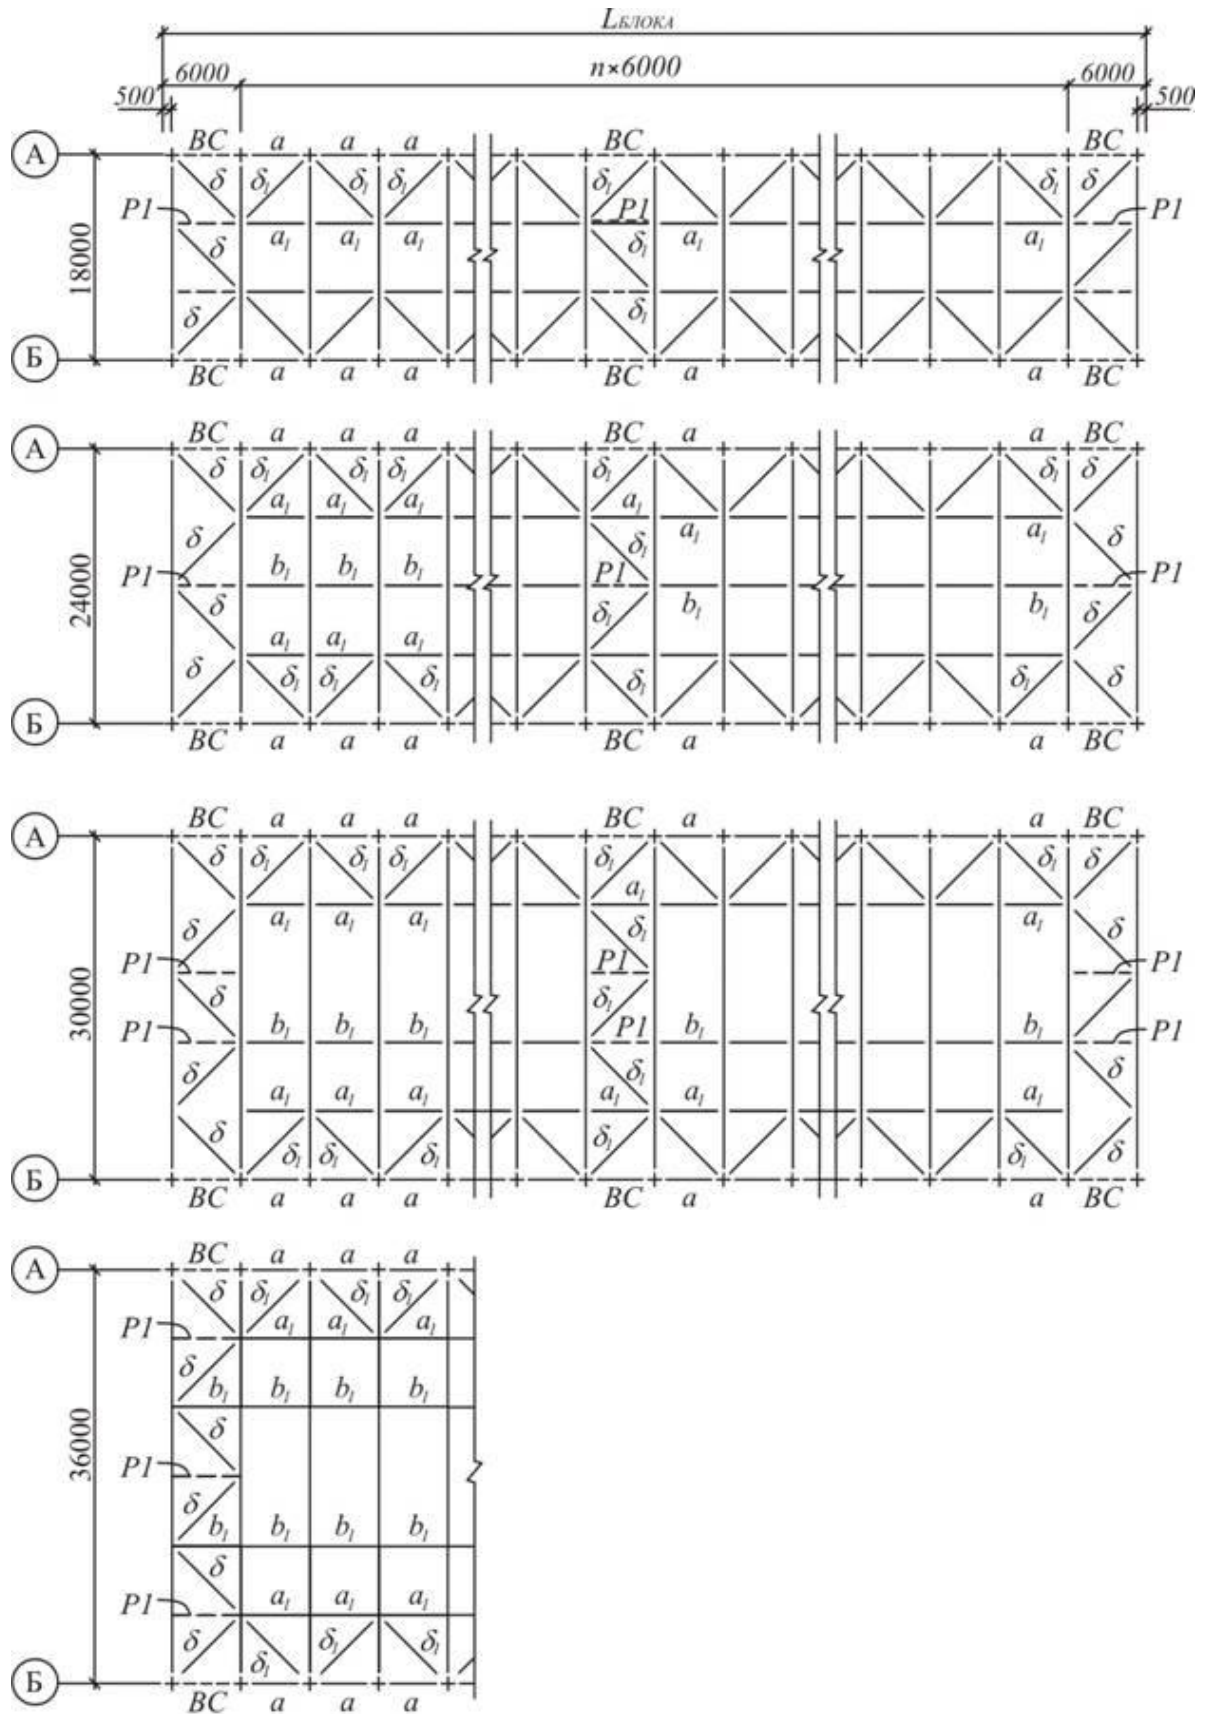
Зв'язки по нижніх поясах ферм, крок ферм – 6 м
